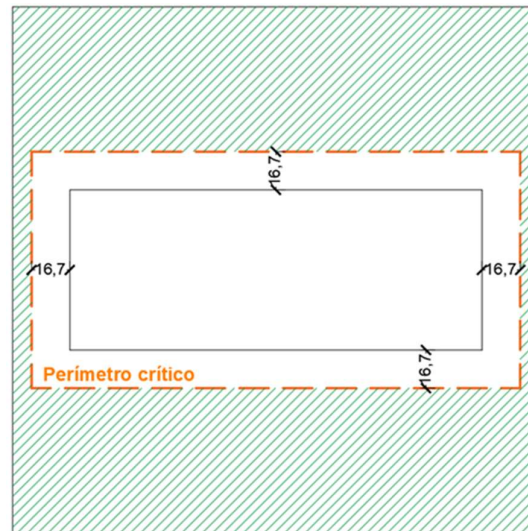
| Perímetro crítico de la zapata a corte en dos direcciones. Fuente: Elaboración propia.
